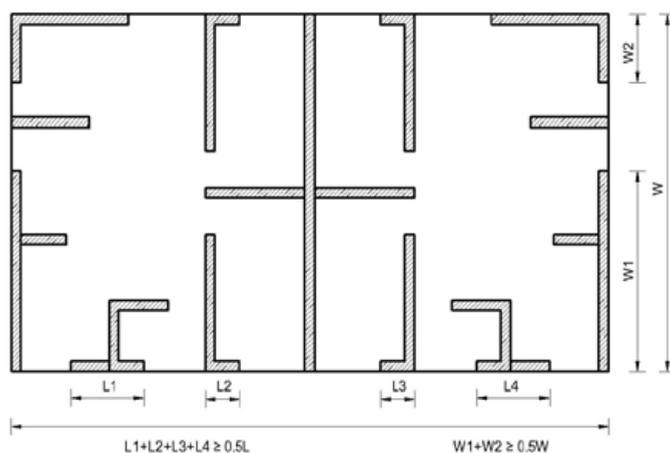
Distribución de muros mampostería confinada en dos direcciones
